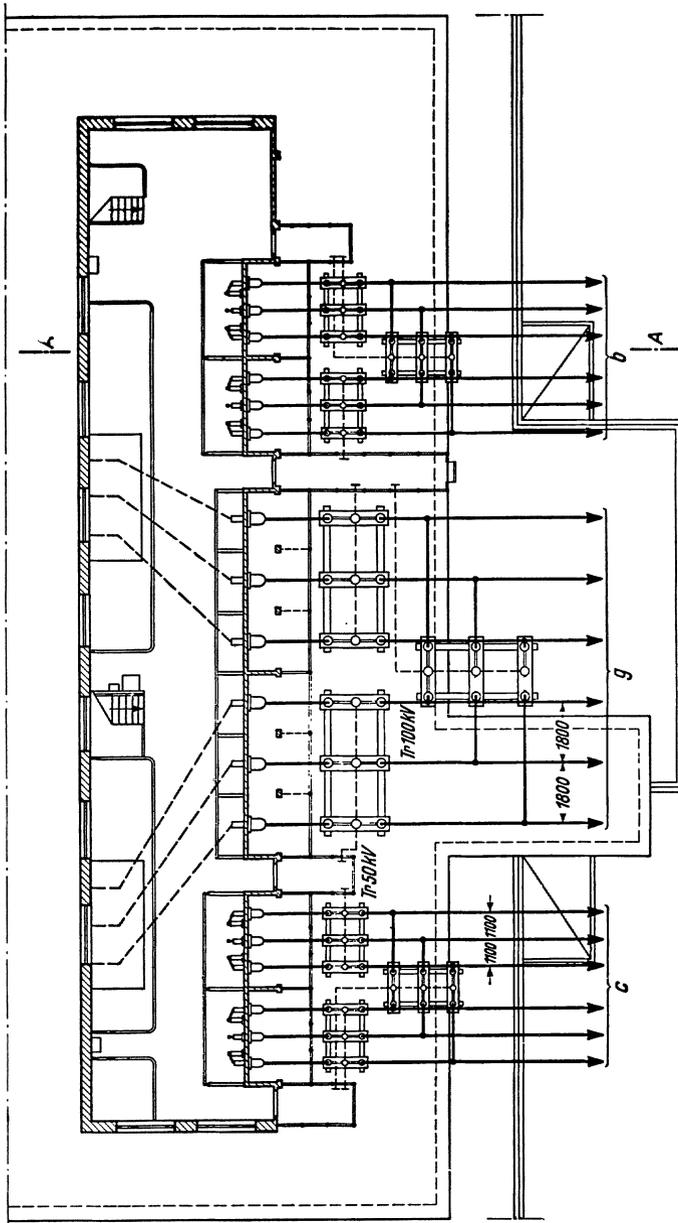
Grundriß für Querschienenanbau zwischen den 100- und 50-kV-Leitungen.
